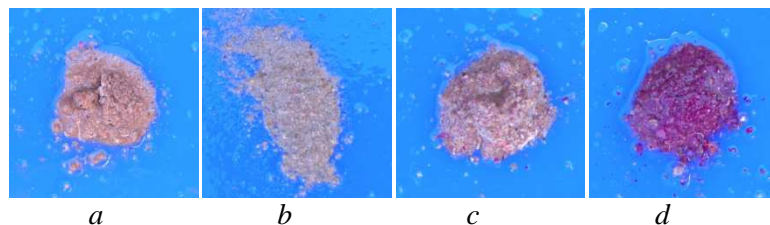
Prova alla fenolftaleina sui 4 prelievi di polvere di calcestruzzo del campione 1-PD-1(a-d), disposti in profondità crescente.
